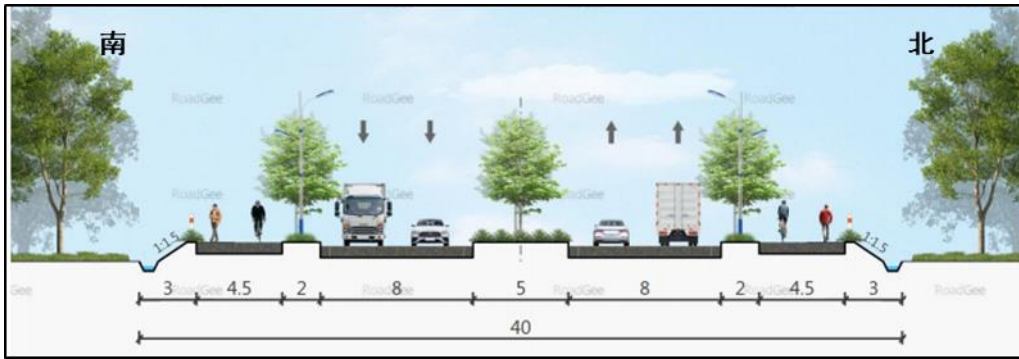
合作公路~终点标准横断面布置图 单位：m
